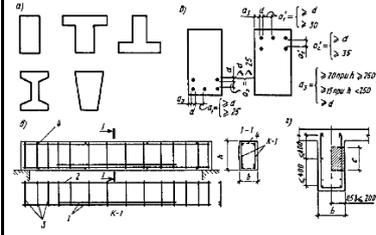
Формы поперечного сечения и армирование железобетонных балок: а — возможные формы сечений; б — размещение продольной арматуры в сечении; в — армирование односторонней железобетонной балки; г — определение площади дополнительной арматуры у боковой грани балки при l > 700 мм; 1 — рабочая арматура; 2 — монтажная арматура; 3 — поперечная арматура; 4 — соединительная арматура
